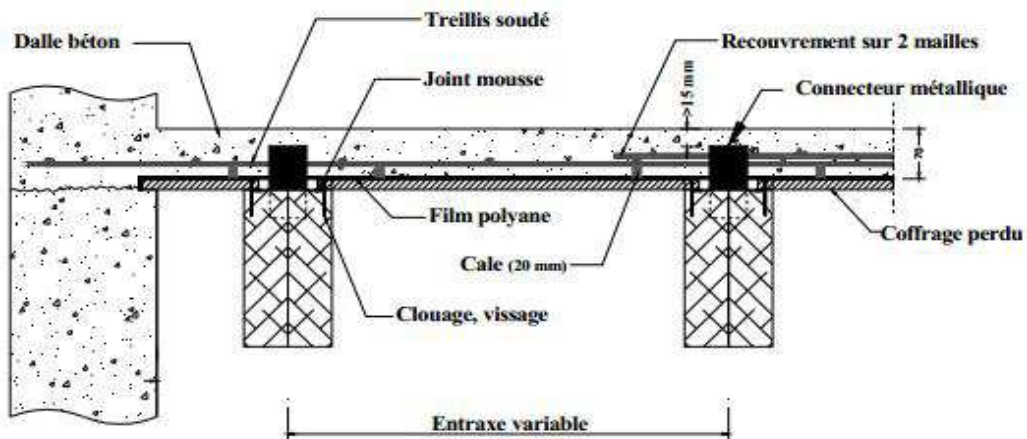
Schéma d'un plancher mixte D-Dalle.
